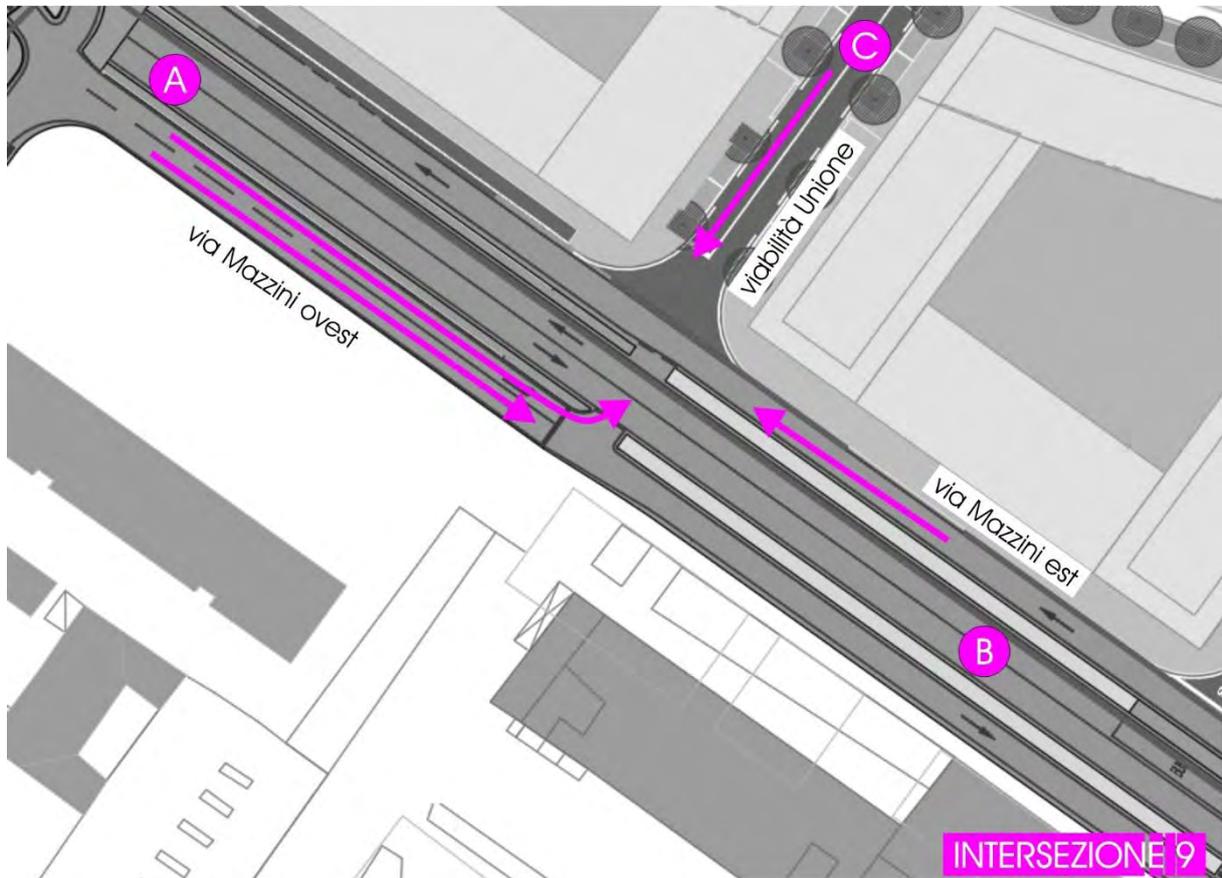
Scenario di Intervento 1 – Planimetria intersezione 9
